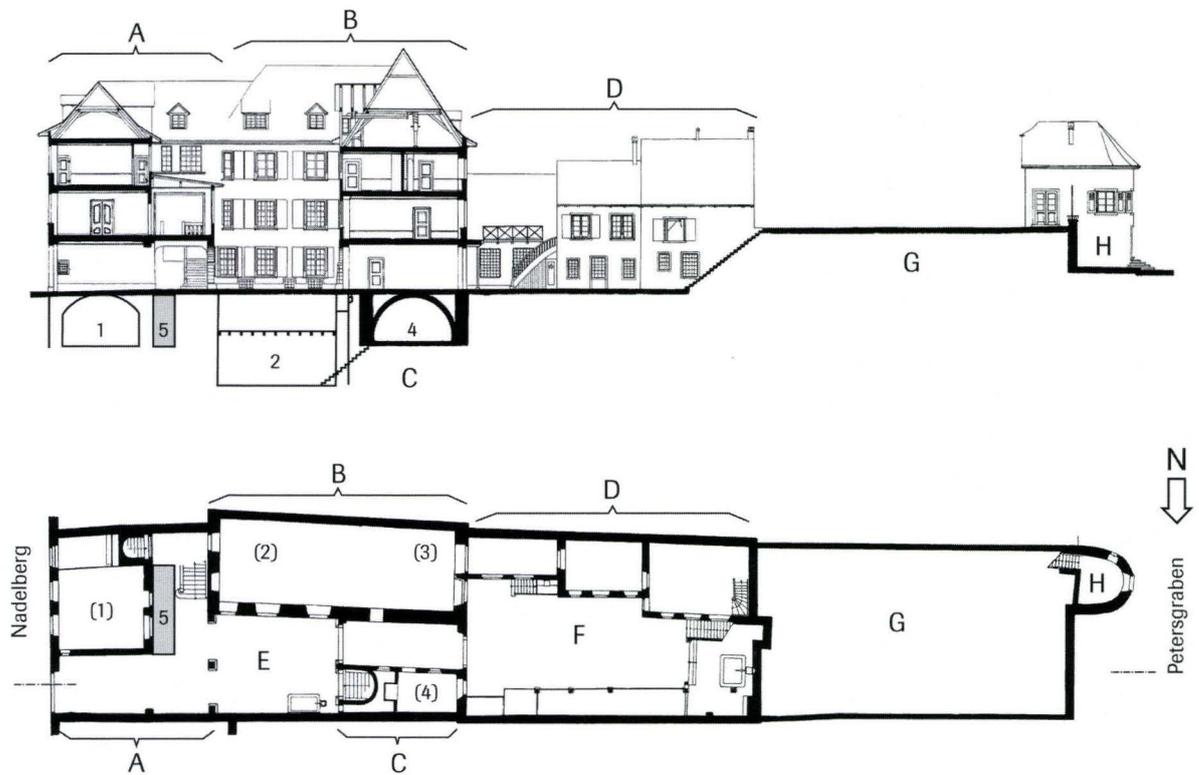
Nadelberg 10, Zerkindenhof (2000/24). Grundriss (Erdgeschoss) und Längsschnitt durch die Liegenschaft. – Zeichnung: Christian Stegmüller.
